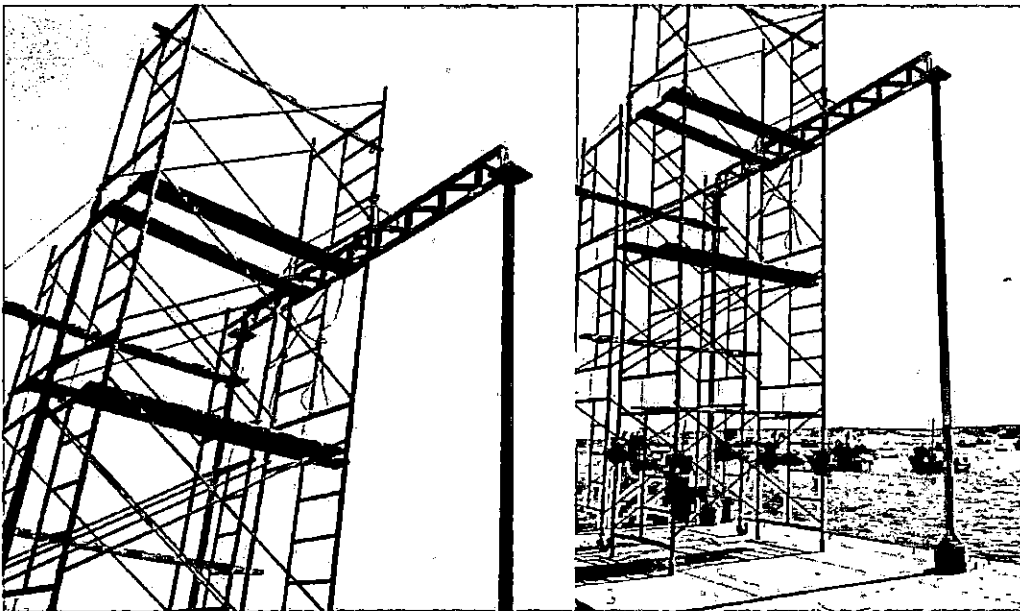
Fijación de la vigueta con soldadura.
